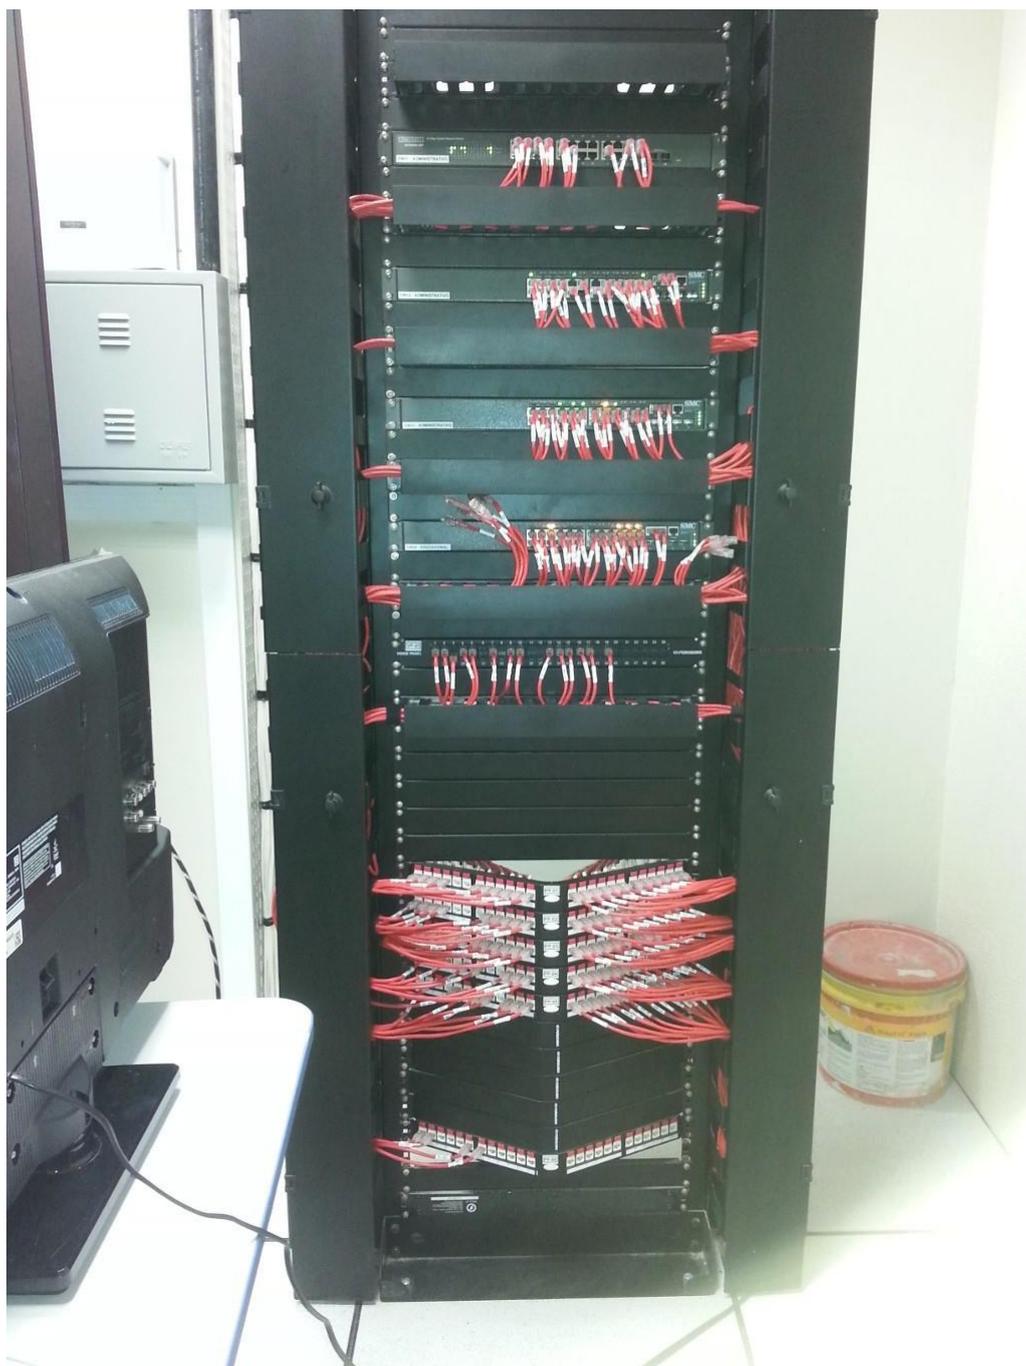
Foto de exemplo 2 montagem rack aberto.
